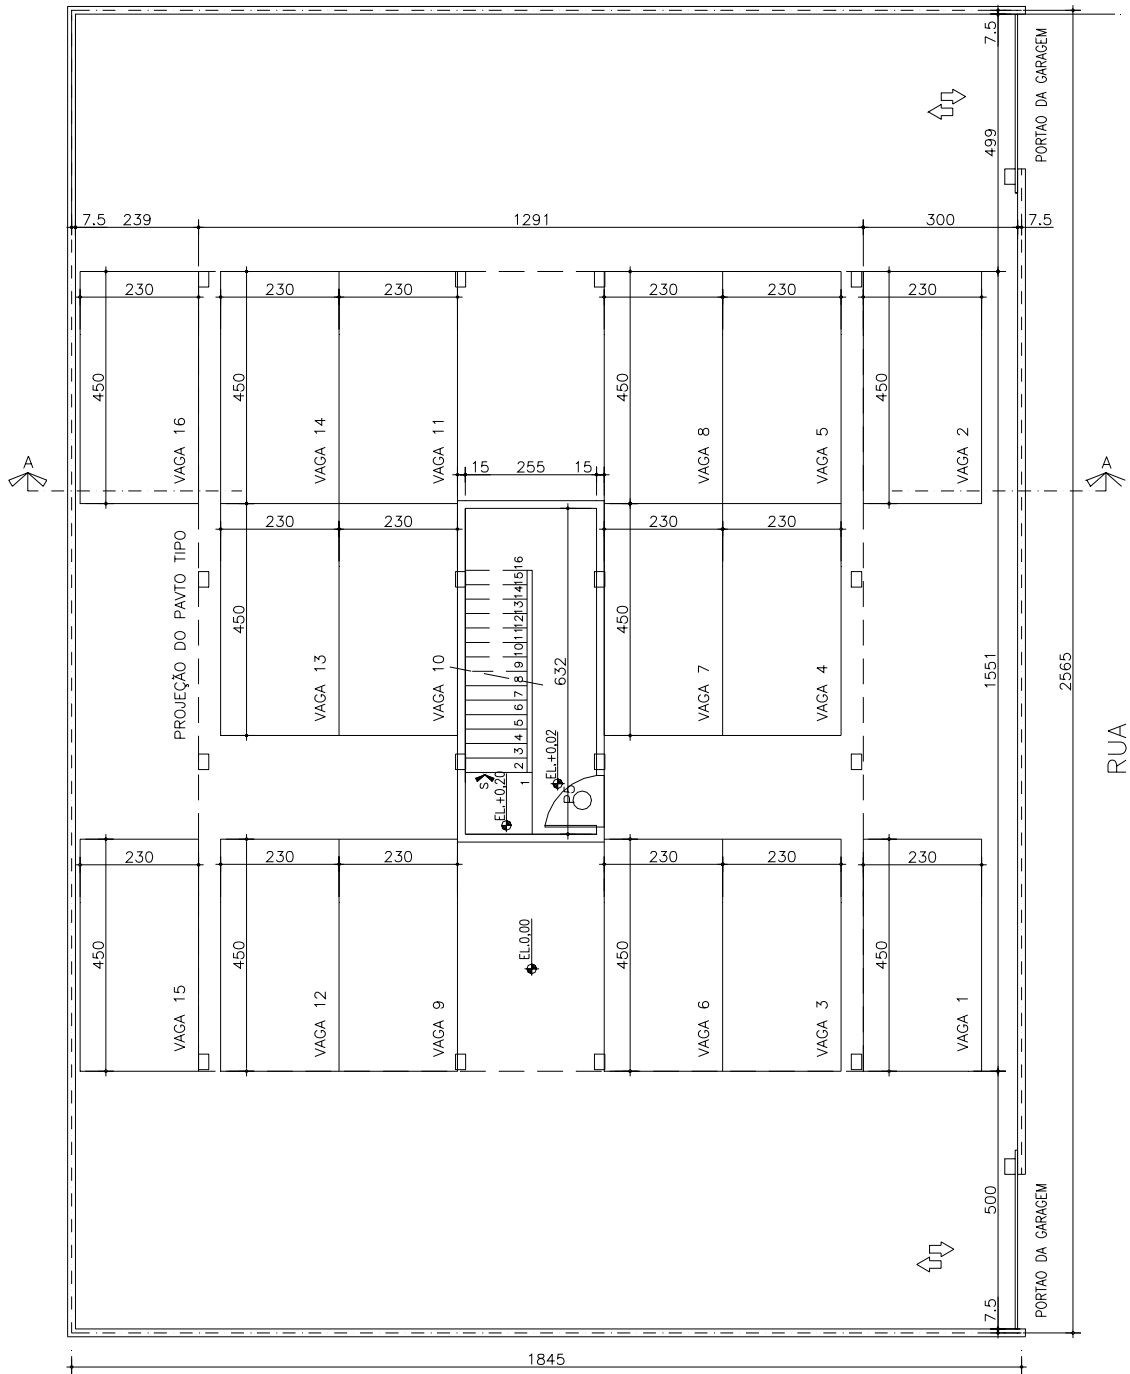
Prédio “M” – Opção 3 – Planta da Garagem
